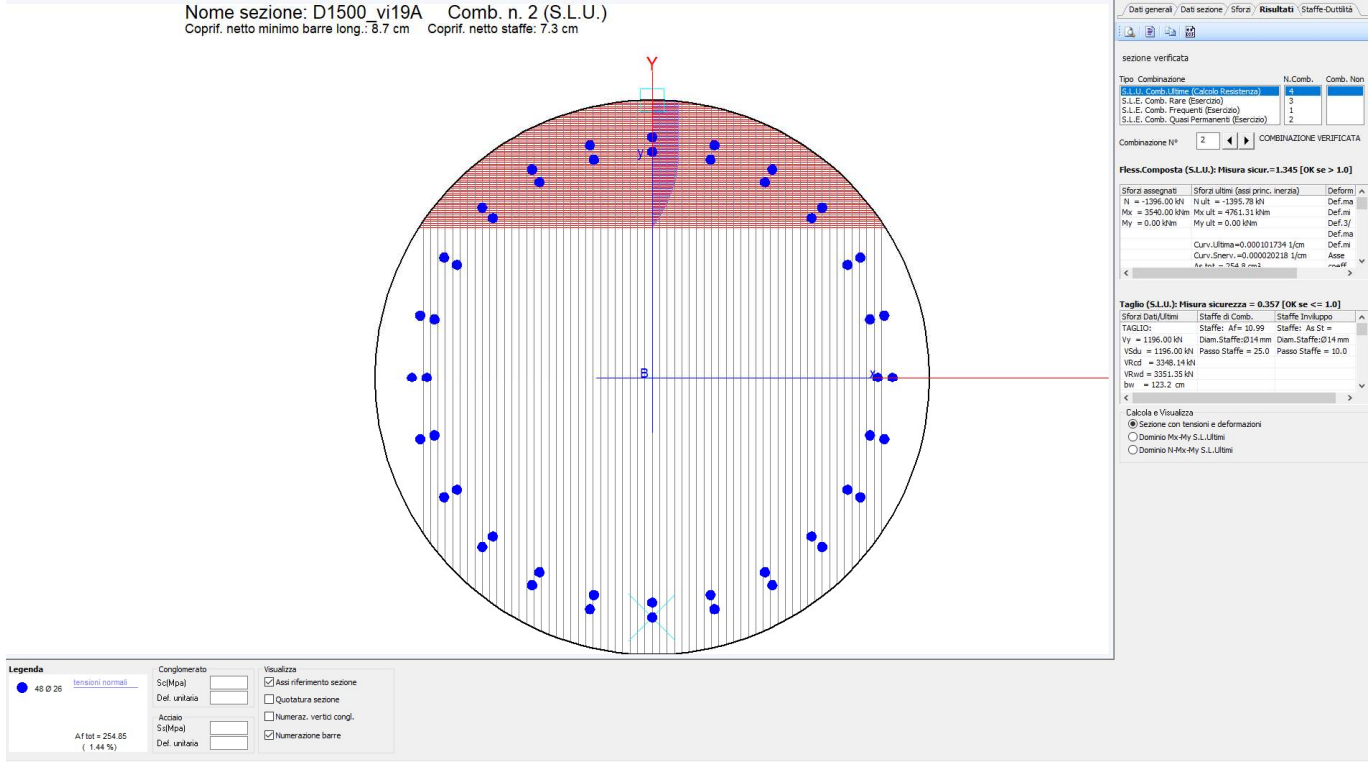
Verifica strutturale palo spalla fissa
